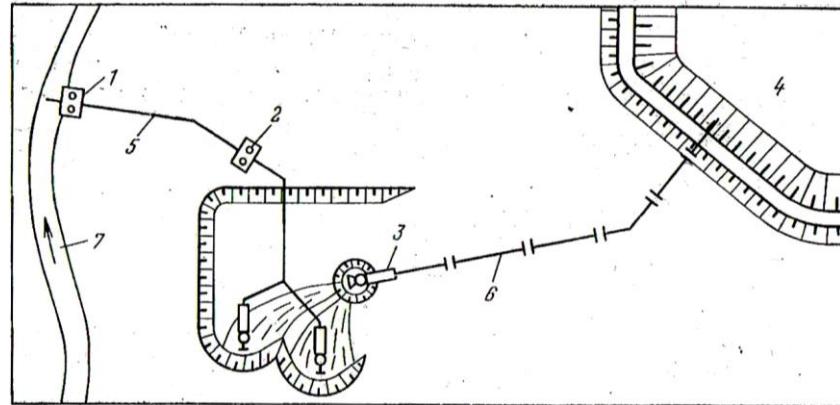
Схема прямого водоснабжения на угольном карьере:
